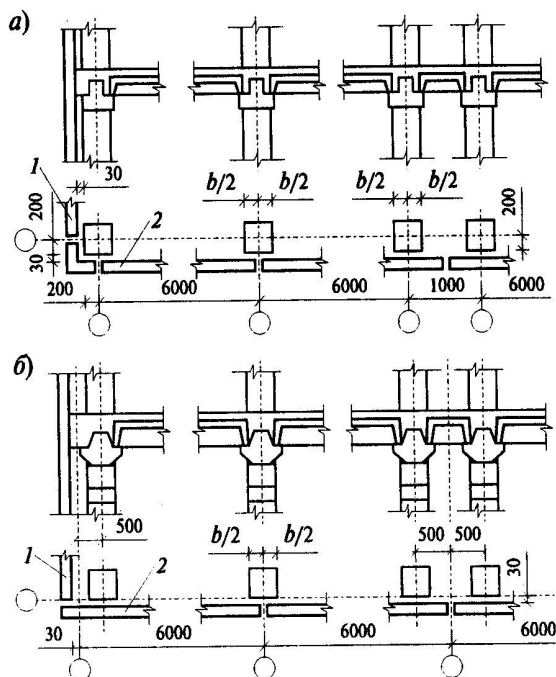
Привязка колонн и наружных стен многоэтажных зданий к продольным и поперечным разбивочным осям и в местах температурных швов: а) в зданиях с нормативными нагрузками на перекрытие 5-10 кПа; б) то же, с нагрузками 10-25 кПа; 1- торцевая стена; 2- продольная стена
